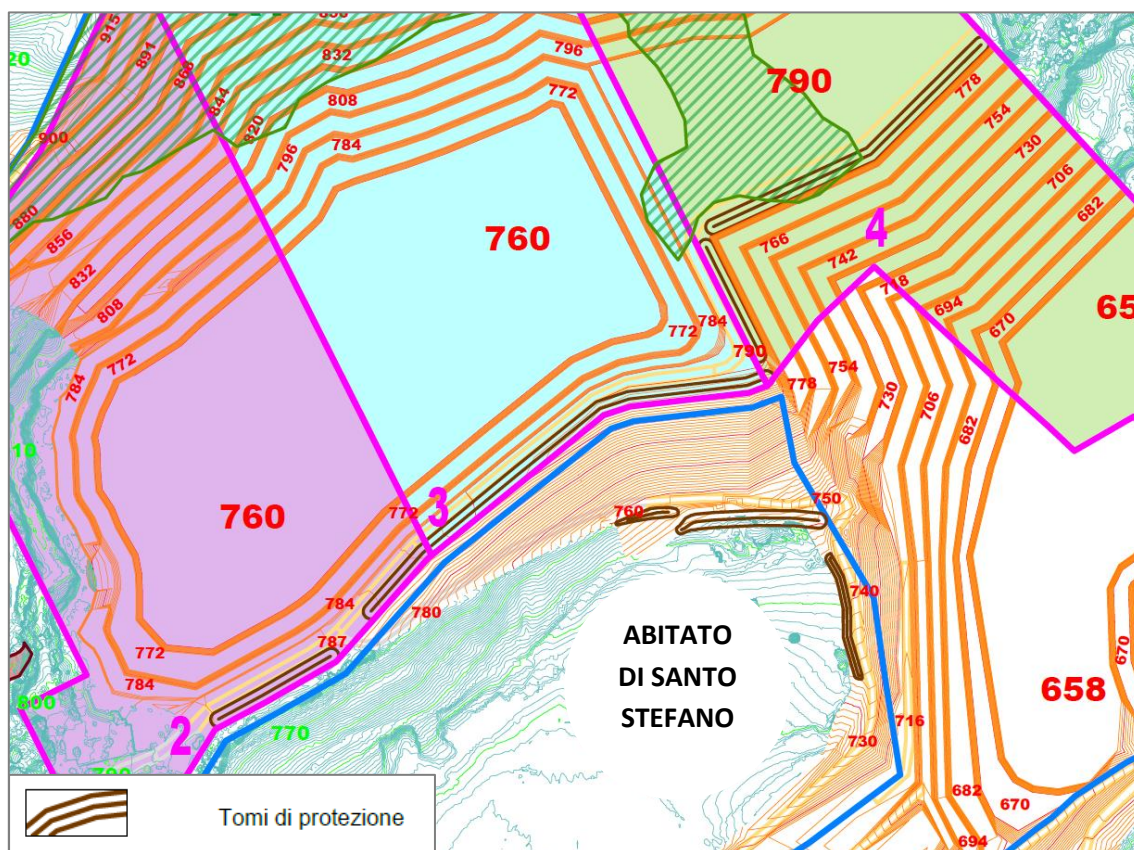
Profilo di progetto dei tomi previsti – Estratto Tav. B di progetto
